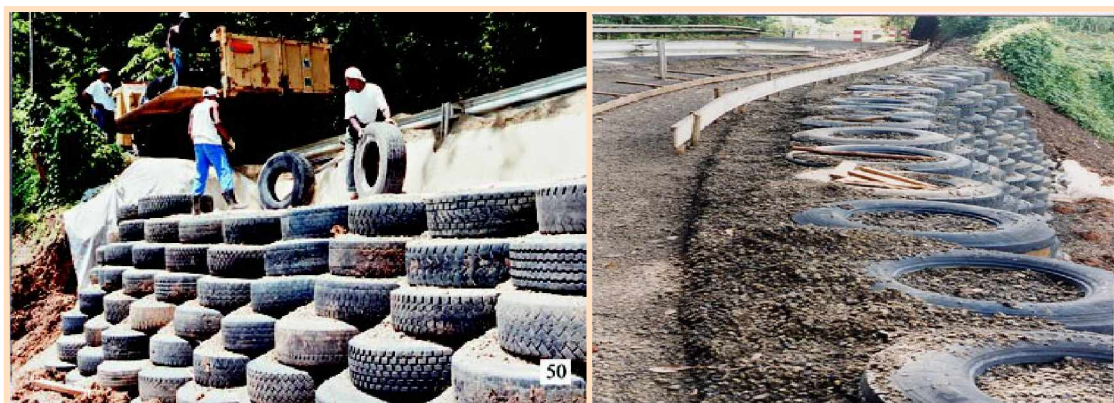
Mise en place d'un massif en pneusol au sur l'accotement d'une chaussée classique
